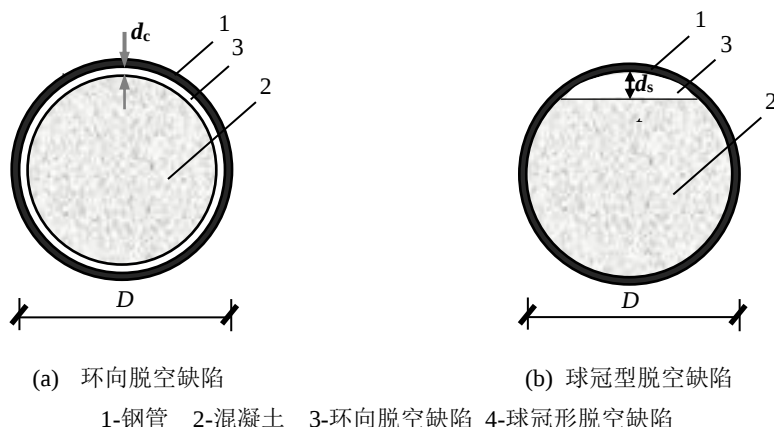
钢管混凝土的脱空缺陷
